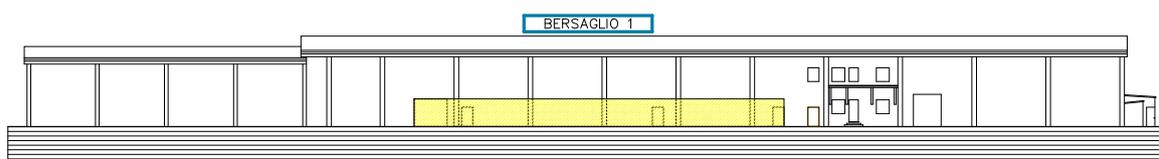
Determinazione delle piastre radianti sul piano radiante 1.
